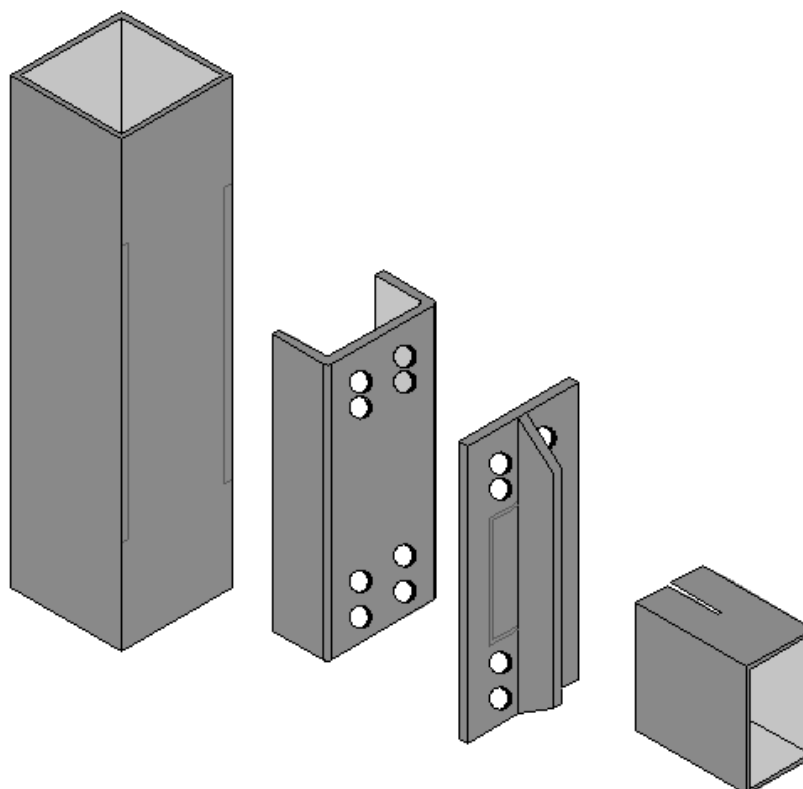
Elementos constituintes da ligação: Pilar, “reverse channel”, chapa de topo e viga
